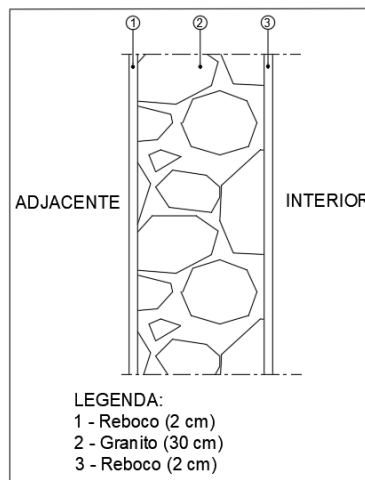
Pormenor construtivo da parede sala/ edifício adjacente
